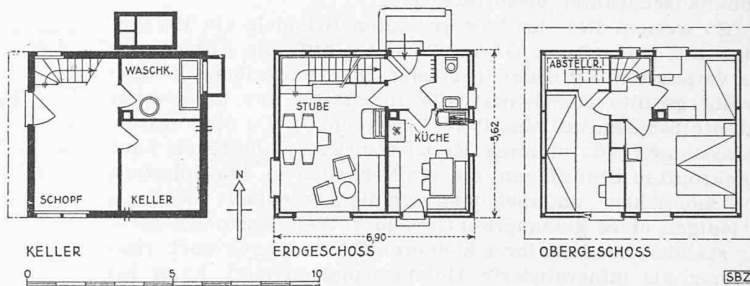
Grundrisse zu Bild 5, Masstab 1 : 250
